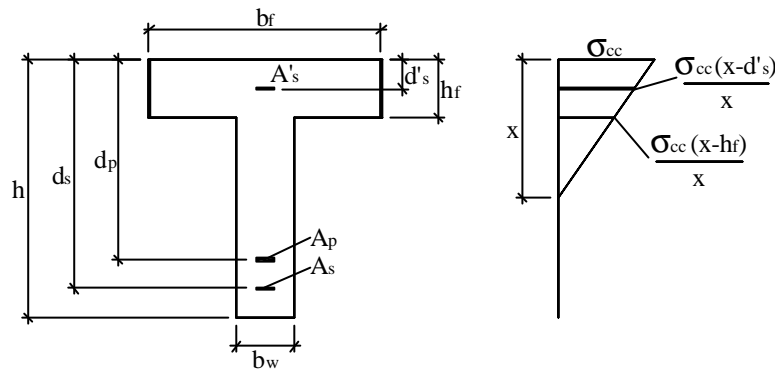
Seção transversal da viga e diagrama de tensões da seção fissurada
